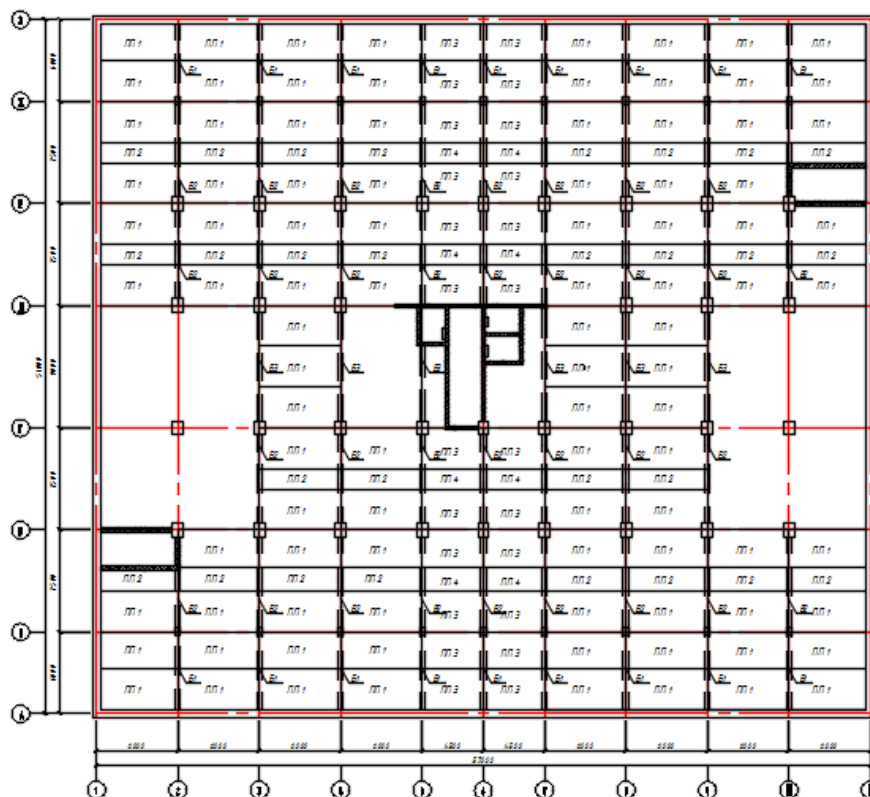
Сборное перекрытие на отметке -10,620 м
